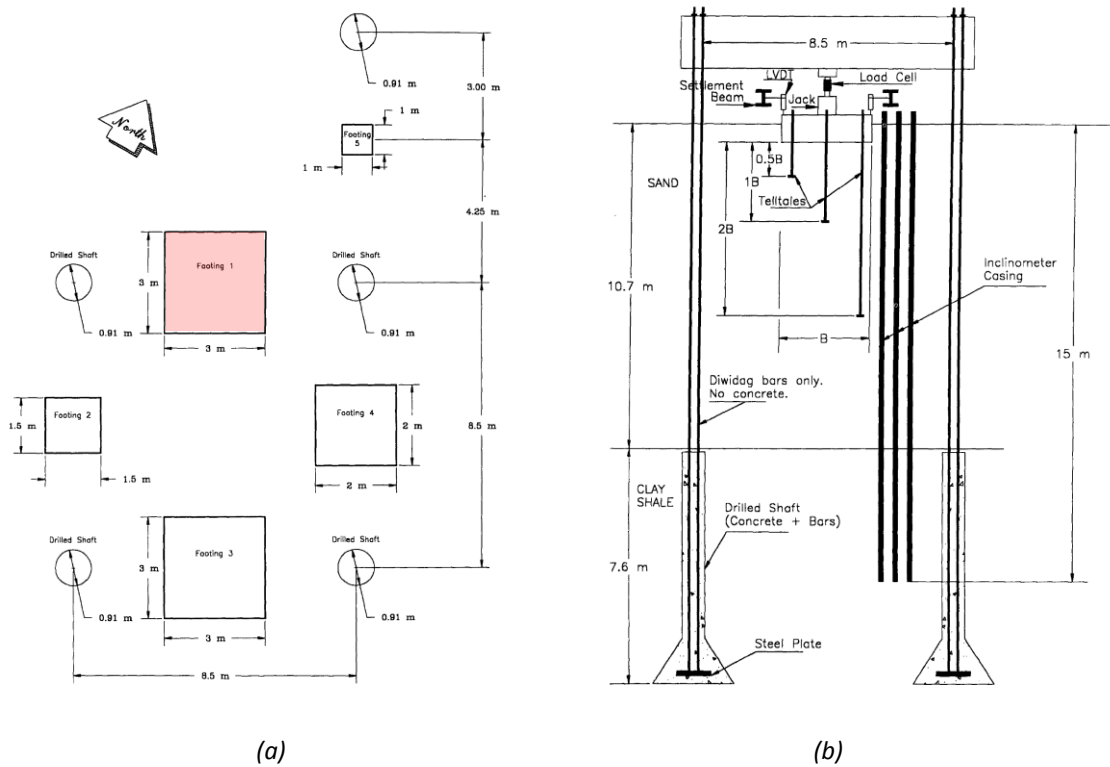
(a) Planta con la situación y las dimensiones de las zapatas. (b) Geometría en alzado del experimento llevado a cabo y del terreno subyacente. Briaud y Gibbens (1997).
